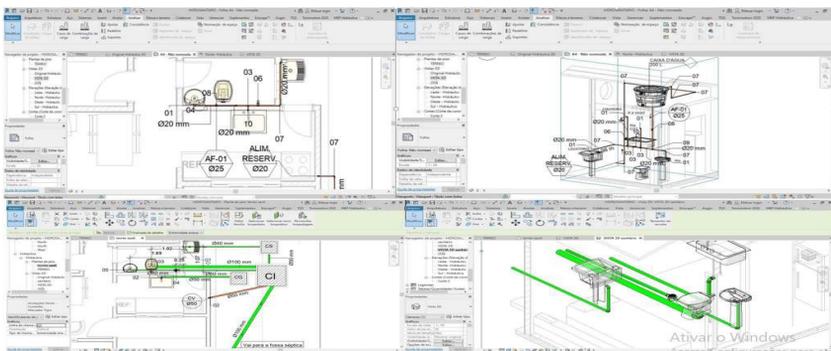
Planta baixa hidráulica/ sanitária – isométrico (vista).
